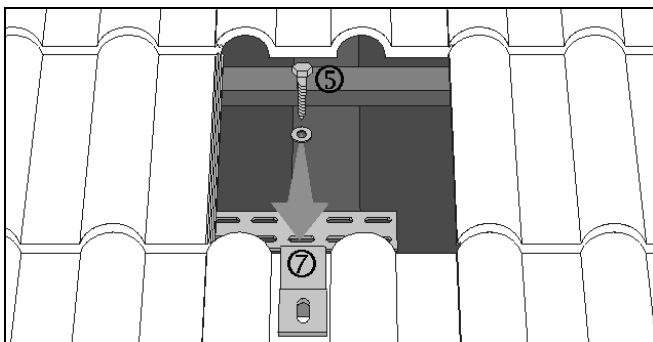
Die Sparrenanker mit einer Wasserwaage horizontal ausrichten und mit Holzschrauben und Unterscheiben montieren. Zwei Schrauben pro Sparrenanker verwenden.
